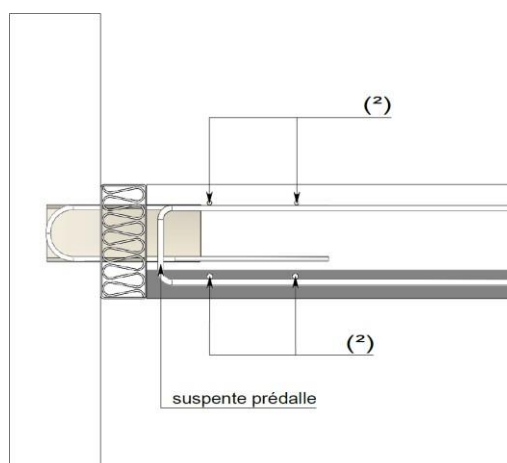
Chainage en rive de plancher – liaison dalle-façade – disposition 2 (vue en coupe)
